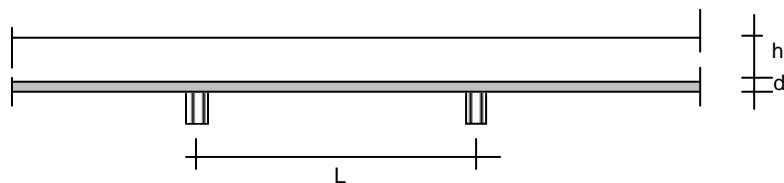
Tekanan yang timbul dalam konstruksi bekisting beton pada waktu pengecoran
